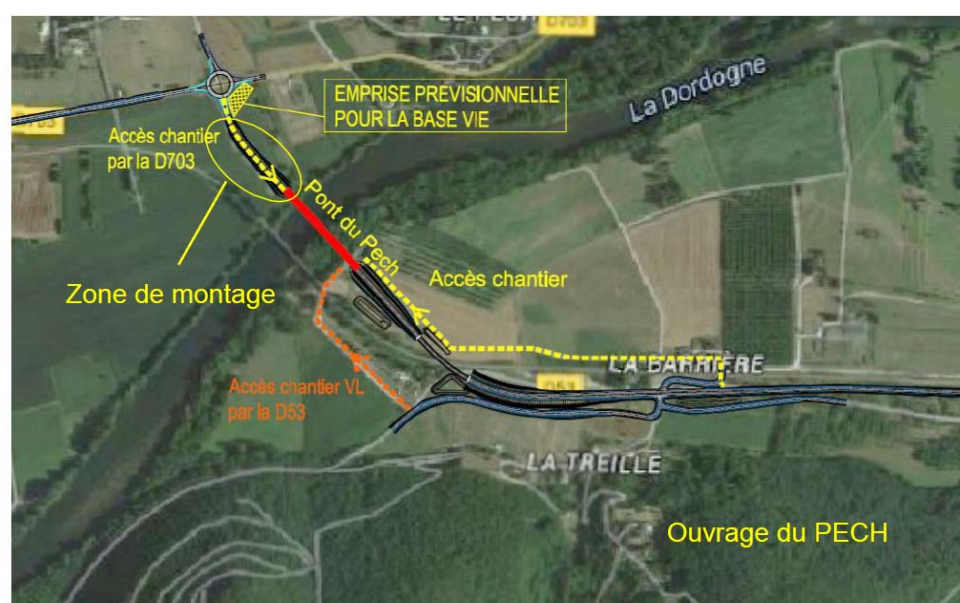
Plan d'implantation de la zone de montage et des accès chantier pour l'OA du Pech (Source : setec tpi, juillet 2016)
